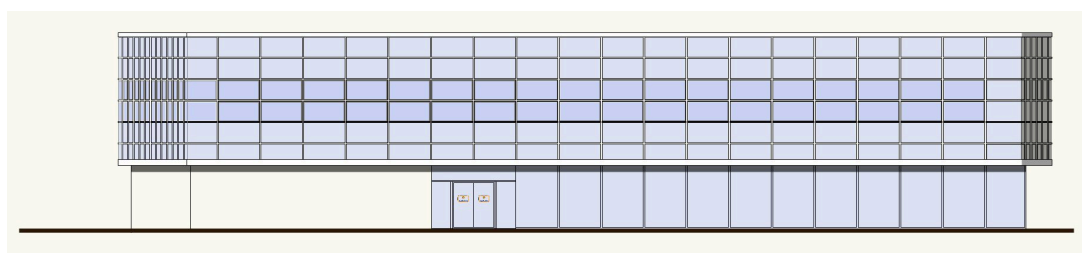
prospetto principale dell'edificio di dimensioni maggiori
